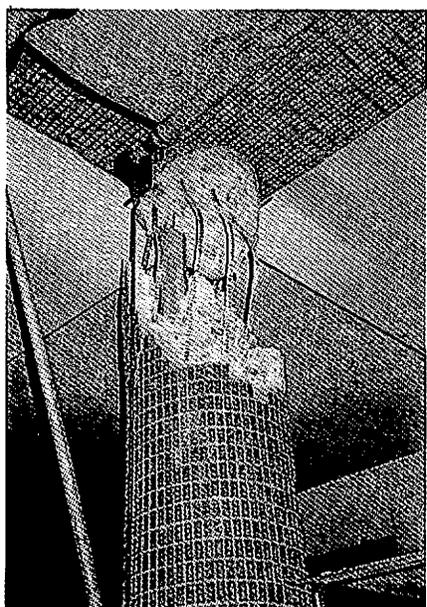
柱の柱頭破壊と埋め込みパイプ
